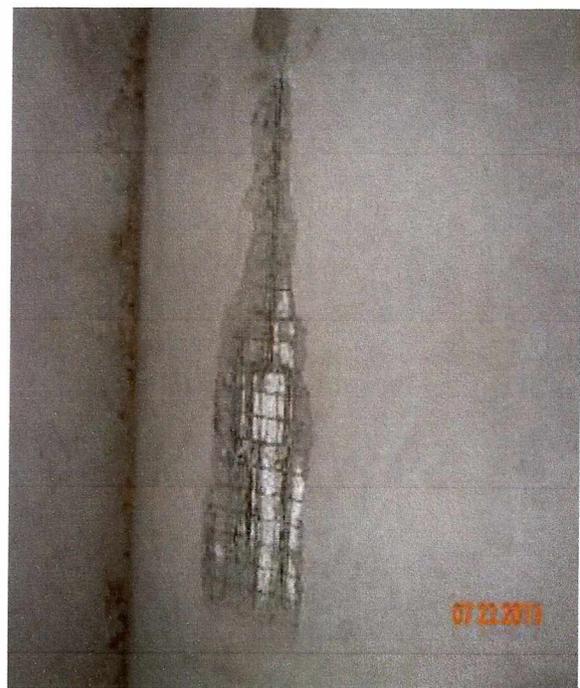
Falla en hormigonado bloque B, vivienda.
